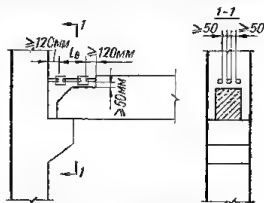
Размещение стыков арматурных стержней при ванной сварке:
